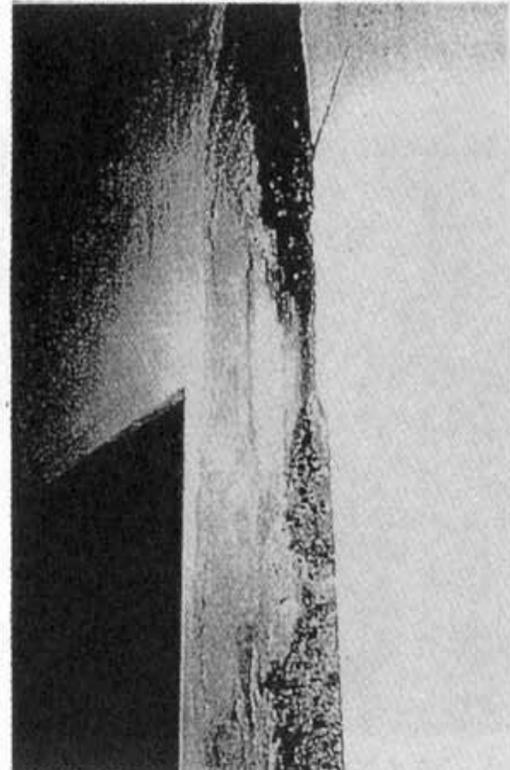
三宮第2駐車場・壁のコンクリート剥落(被害タイプB)
